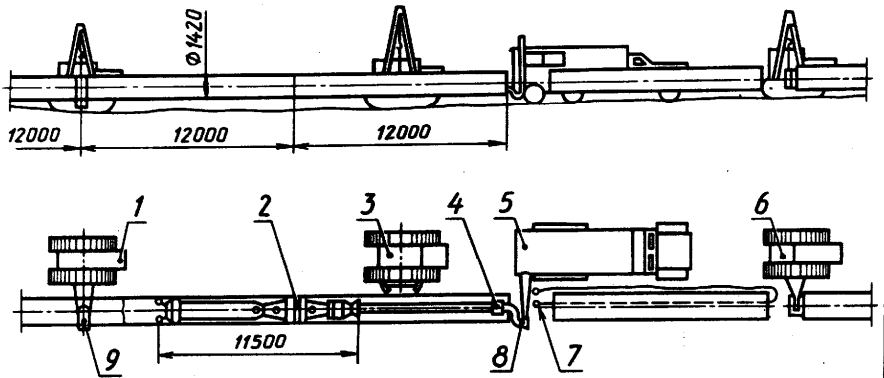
Схема сборки и сварки магистрального трубопровода с помощью внутритрубной машины
